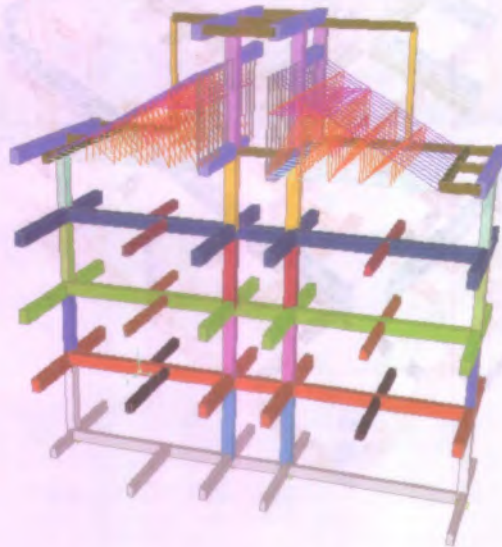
Denah pembalokan lantai atap [+14.50]
